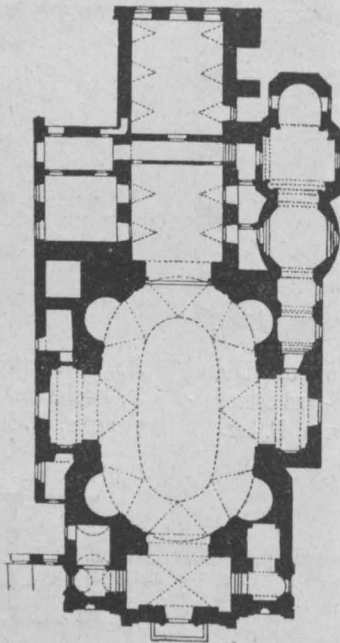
Grundriß der Servitenkirche, IX. Bez.
